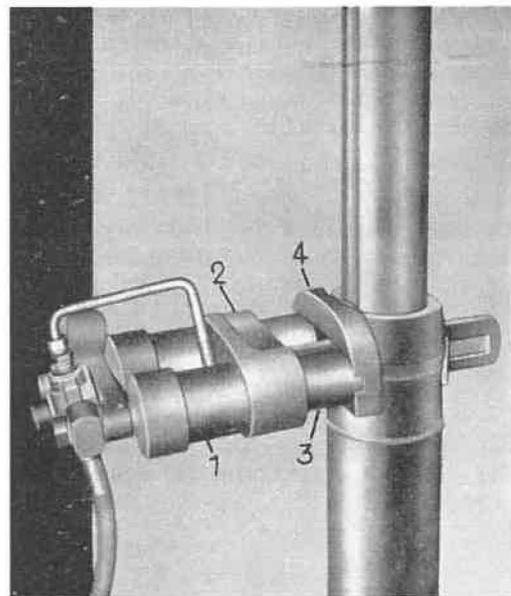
Dispositif hydraulique de calage des serrures d'étançon.
